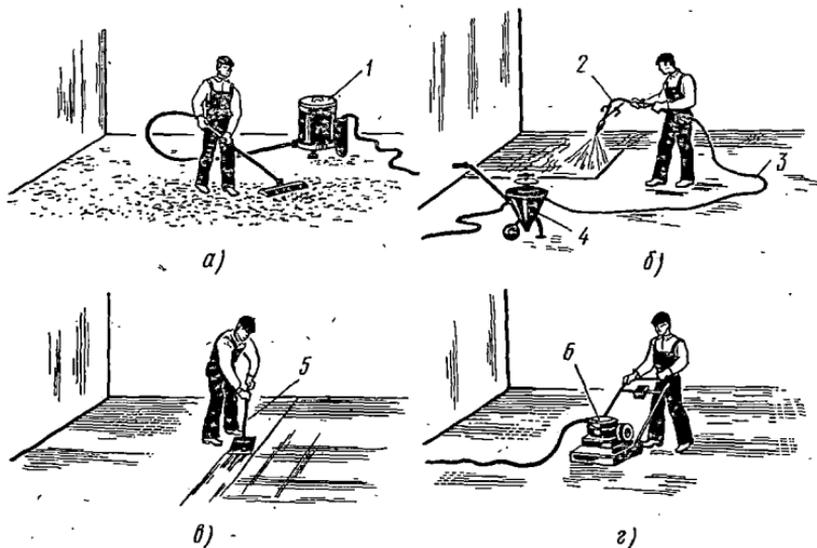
Подготовка основания под мастичные полы: а — обеспыливание, б — огрунтовка, в — шпатлевание, г — шлифование; 1 — промышленный пылесос ПП-1, 2 — форсунка-распылитель, 3 — шланг, 4 — краскораспылительный бачок, 5 — шпатель, 6 — мозаично-шлифовальная машина СО-91
